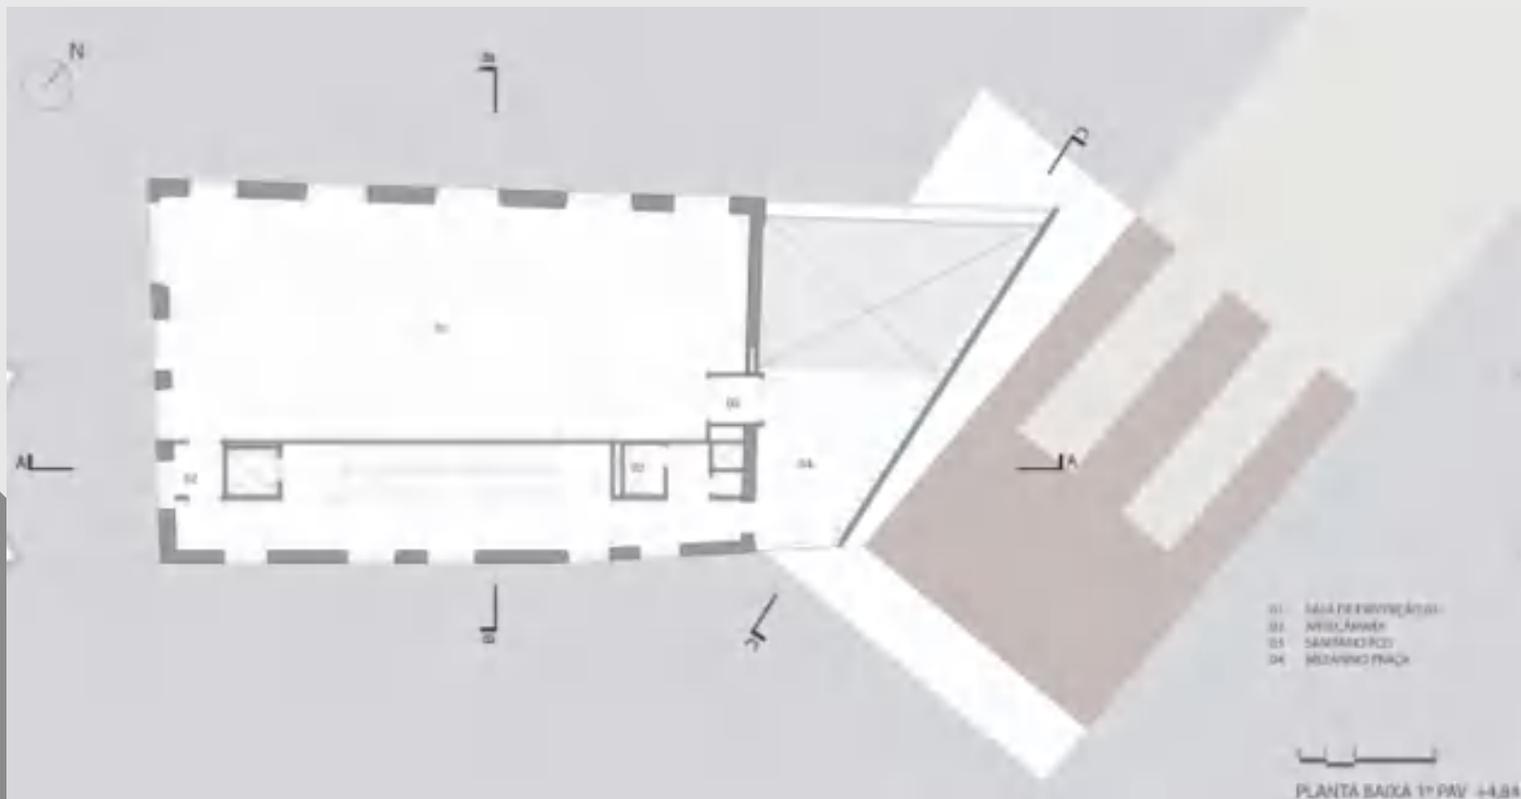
Planta Baixa primeiro pavimento Casa do Carnaval
